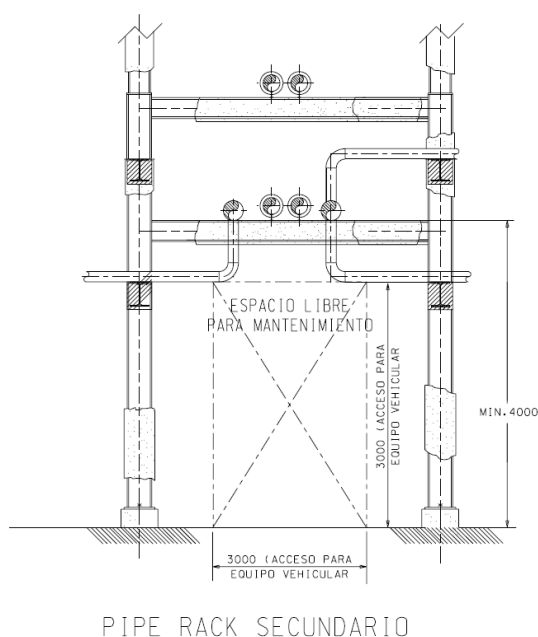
Área de Acceso Pipe Rack Secundario
